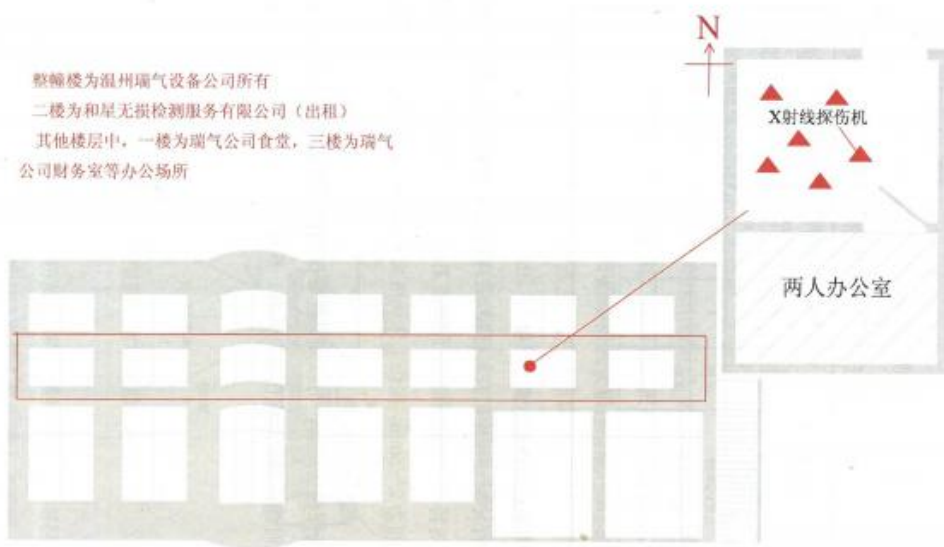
公司租用办公楼立面及二楼近东侧设备间平面布置示意图
